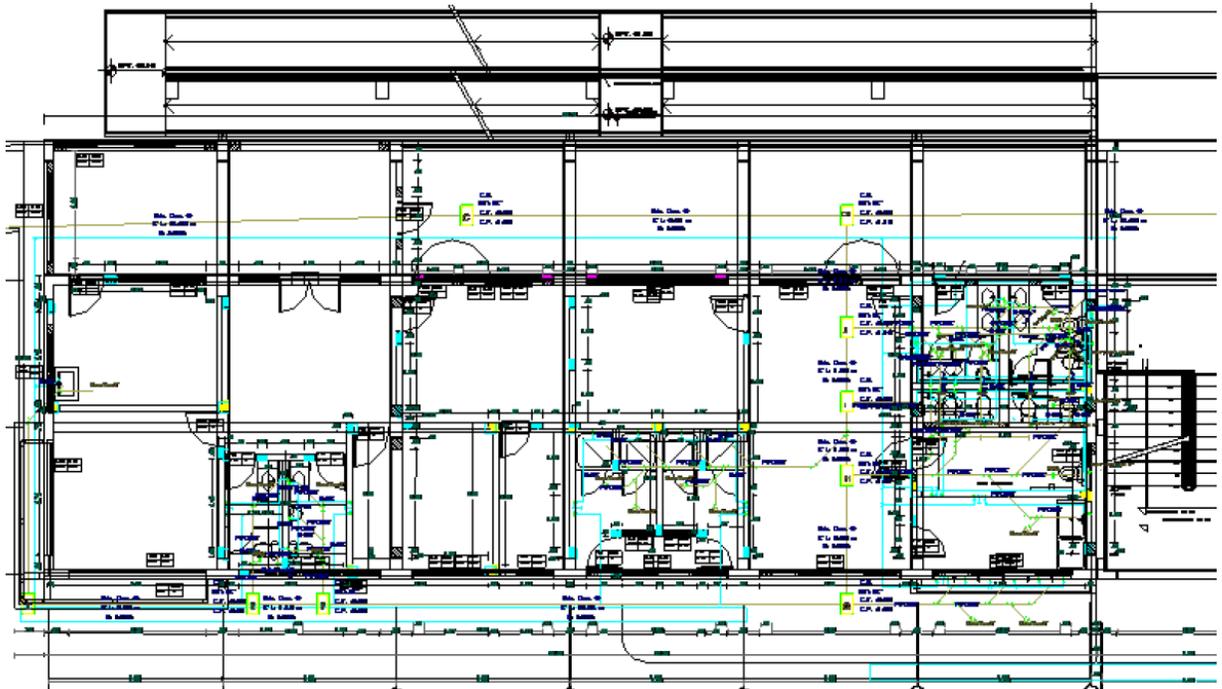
Modelado Arquitectónico 1er Nivel (REVIT)
